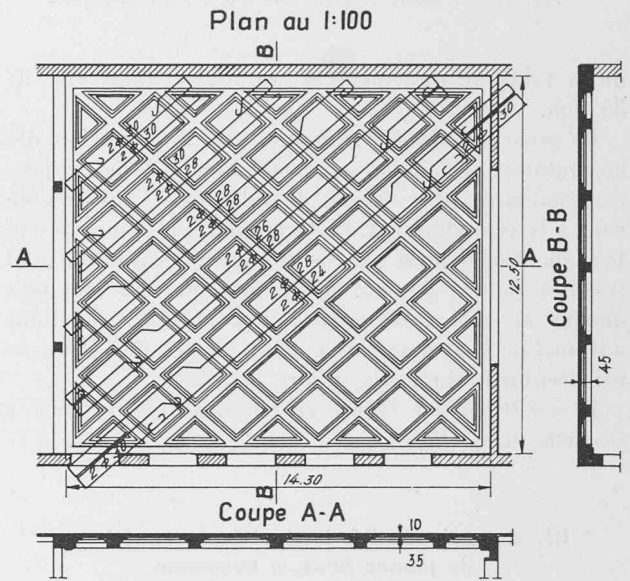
Plan du plafond et coupes. Disposition des armatures principales.
